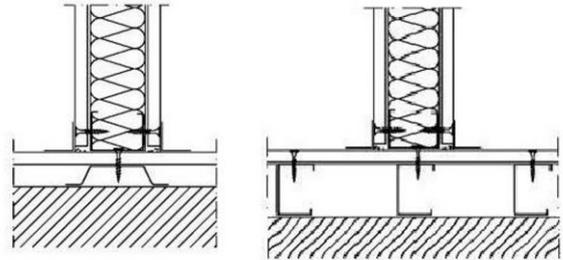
Encuentros entre trasdosado y tabiquería (secciones vistas en planta)
